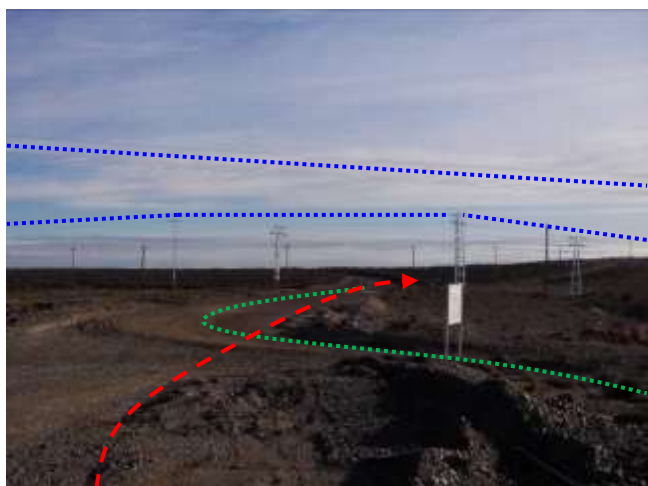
Futuro emplazamiento del oleoducto, interferencia con camino (verde) y dos líneas eléctricas (azul). Foto en dirección Norte.
